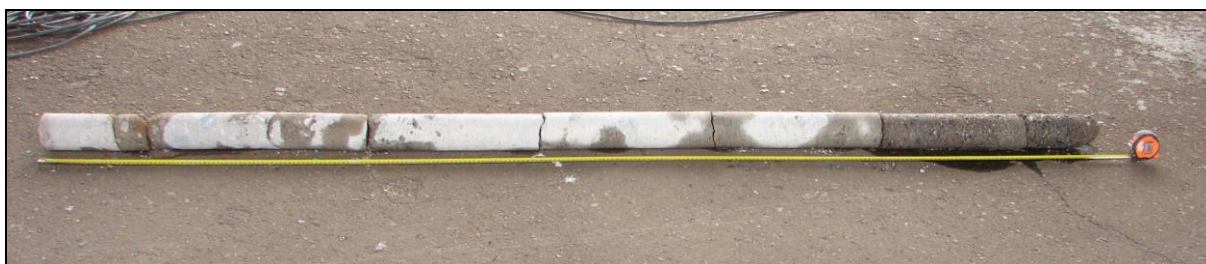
3. nástupiště, základ sloupu 4 (Zpráva 1600 J 195 [11], Příloha 3, foto 61); vizuálně se beton základu jeví jako beton lepší kvality oproti betonu základů sloupů 13 a 2 na 3. nást. diagnostikovaných v tomto doplňkovém STP
